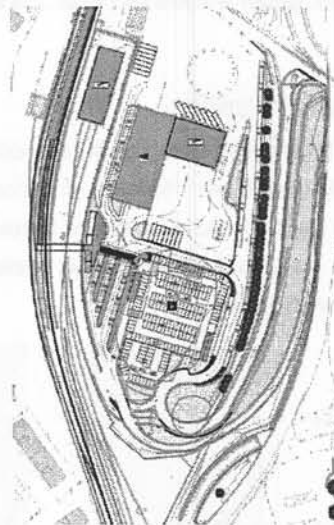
Planimetria Terminal intermodale di Serra Rifusa.
